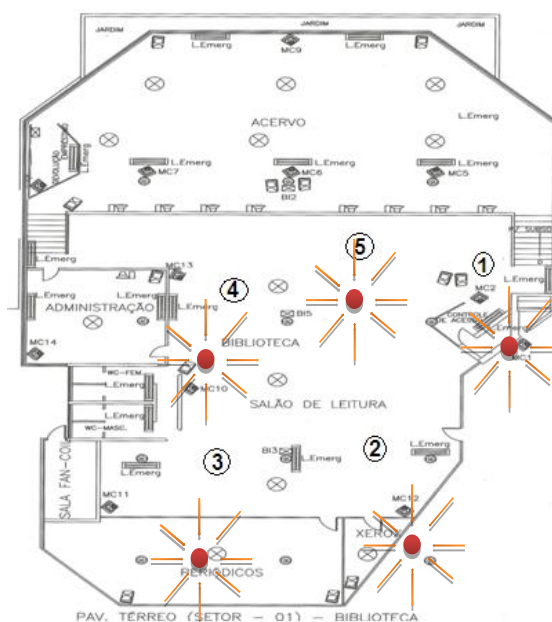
Planta baixa da biblioteca do IFMA, campus Monte Castelo.
